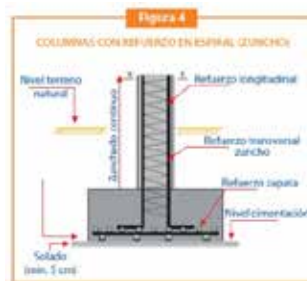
Columna zunchada. Fuente: <http://www.acerosarequipa.com/construccion-de-viviendas/construccion-de-viviendasaprende-linea/construccion-de-viviendasboletin-construyendo/edicion-18/construccion-de-viviendasboletin-construyendoedicion-18capacitandonos-reforzar-columnas-estructurales.html> (2016)
